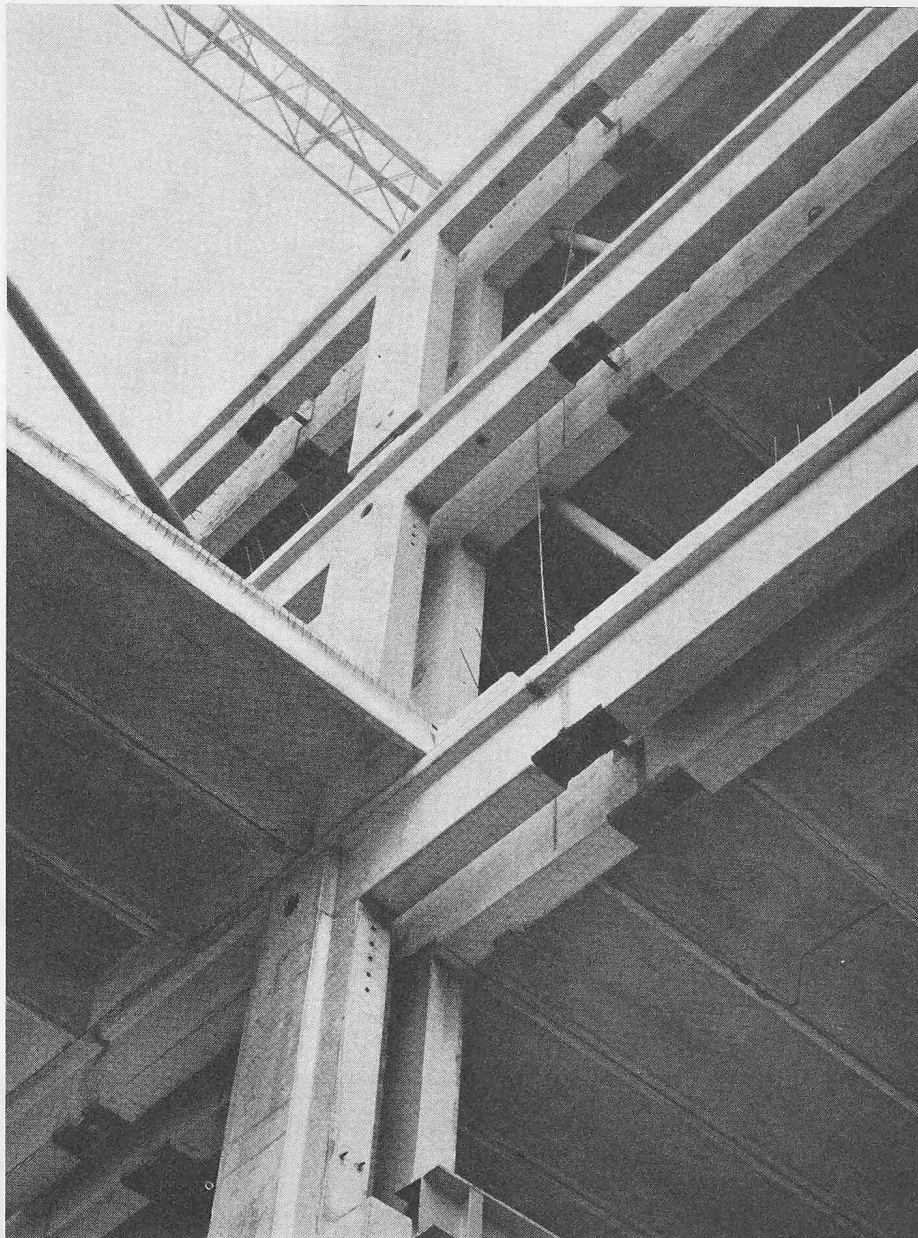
Blick auf die Stösse zwischen den Stützenkonsolen und den Unterzügen. Die Ankerplatten der Elemente werden durch je zwei Laschen miteinander kraftschlüssig verbunden. Dadurch wurde eine rasche und kontinuierliche Montage ermöglicht
